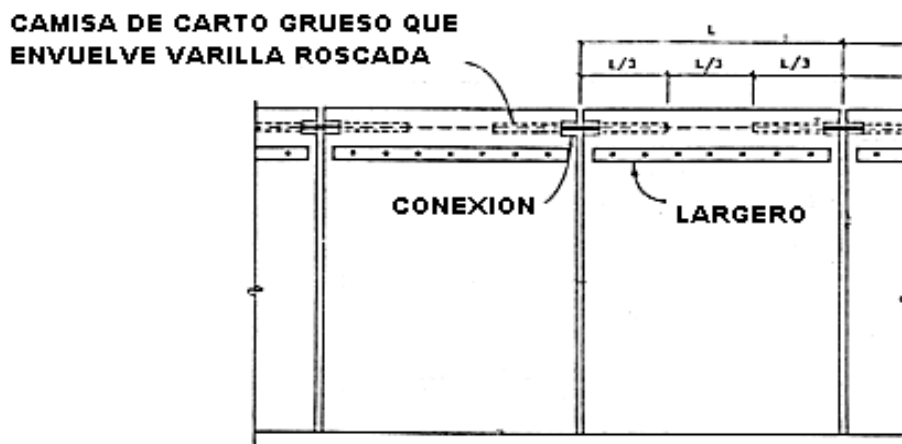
Detalle de conexión de tirante de acero embebido en el muro.
